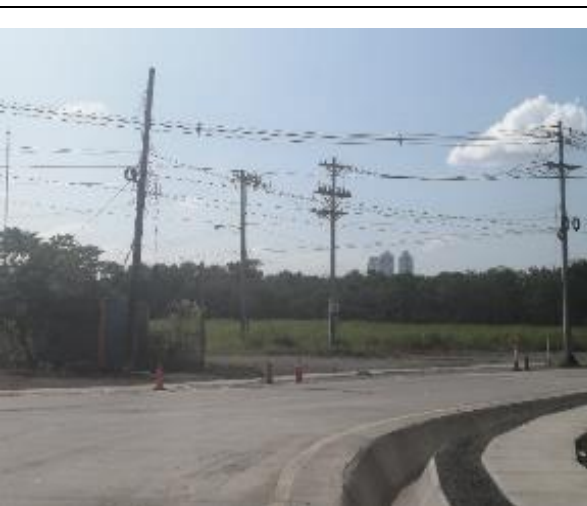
Entrada hacia la Ptar del Saneamiento de la Bahía.
